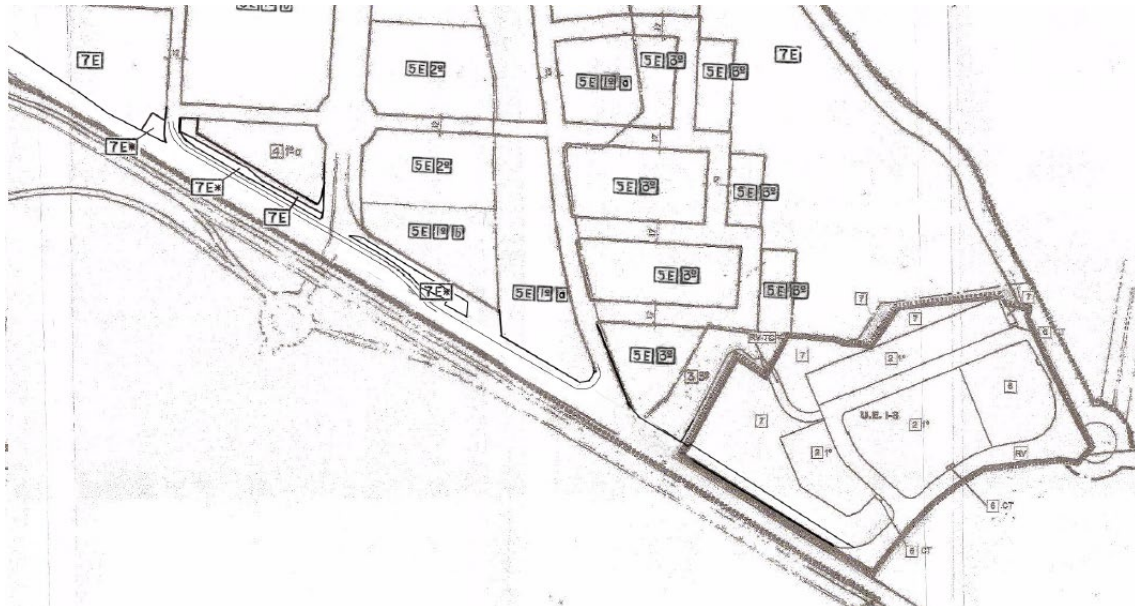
Imagen del plano 5.23 modificado. Zonas verdes junto a la M 505 delimitadas y nueva infraestructura de acceso.
